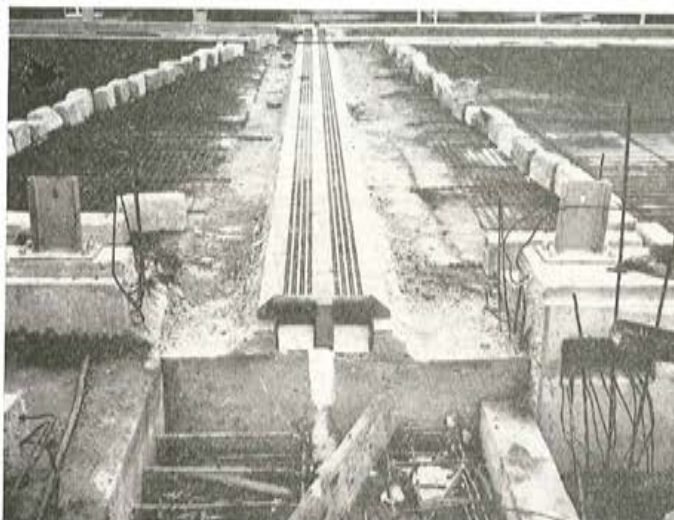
Junta de calzada, del lado de París, durante su colocación.
